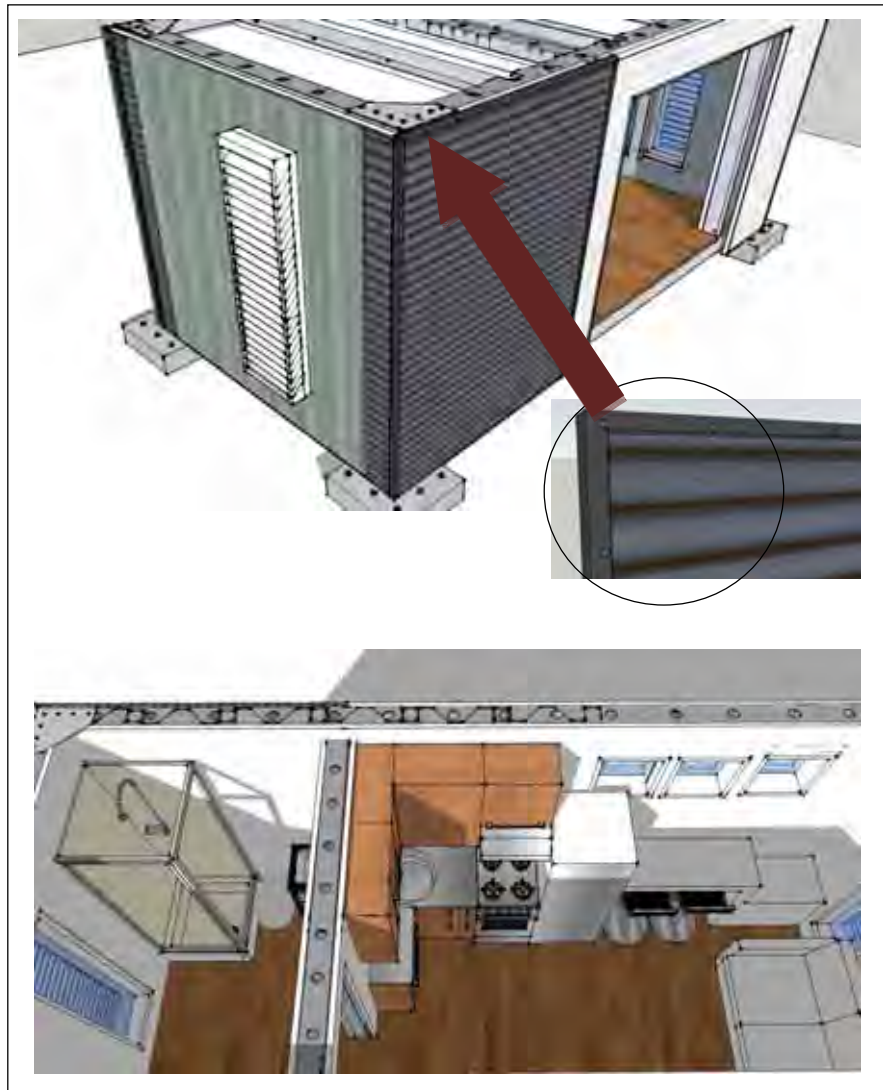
Colocación del acabado. Fuente: Elaboración propia 2008
